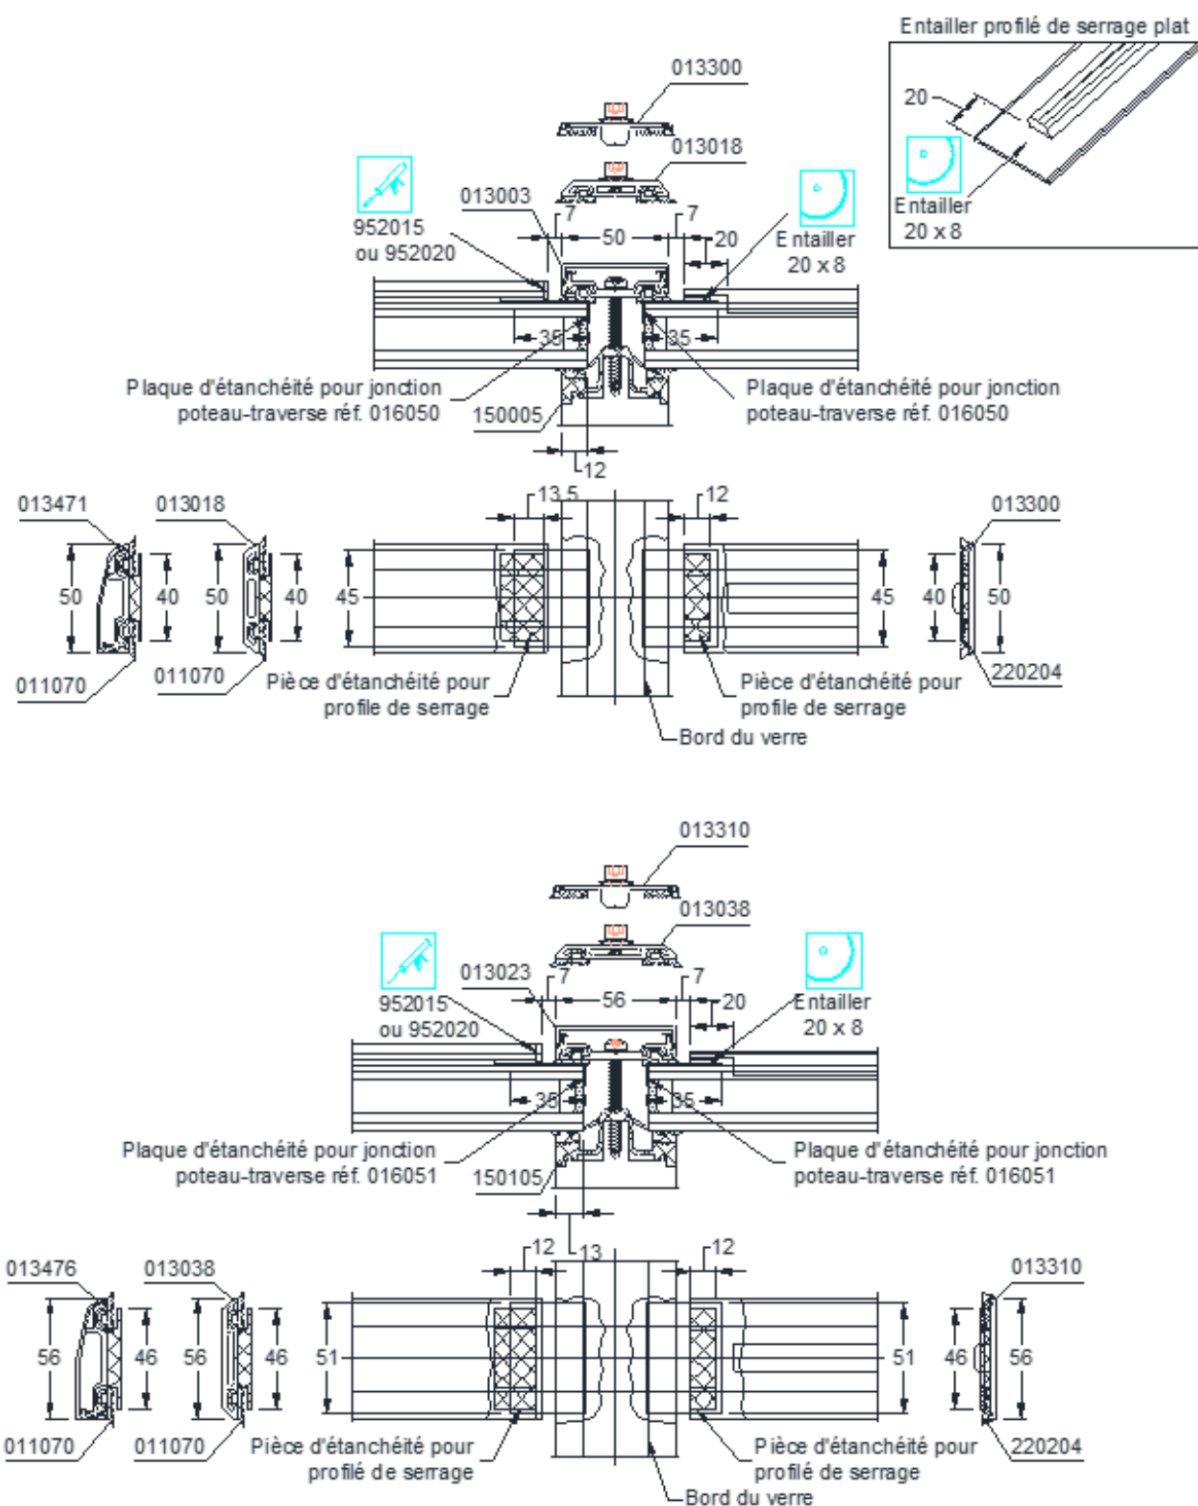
Montage des plaques d'étanchéité de croisement et des pièces d'étanchéité de profilé de serrage : séries 50 et 56
